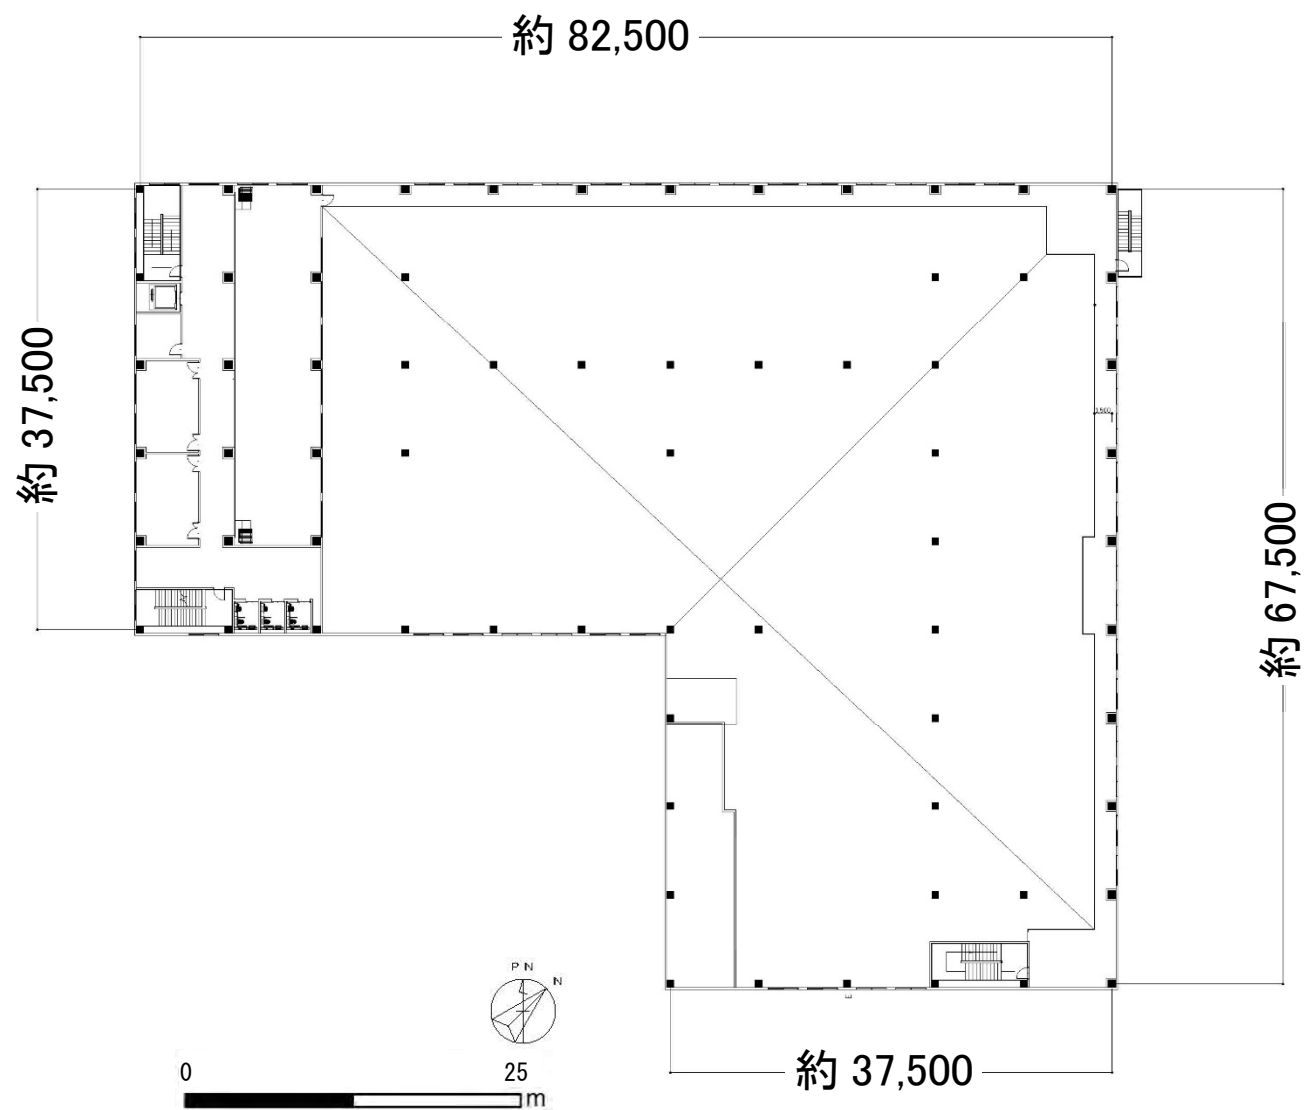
(4) 計画建物平面図 (4 階) : 単位 mm
